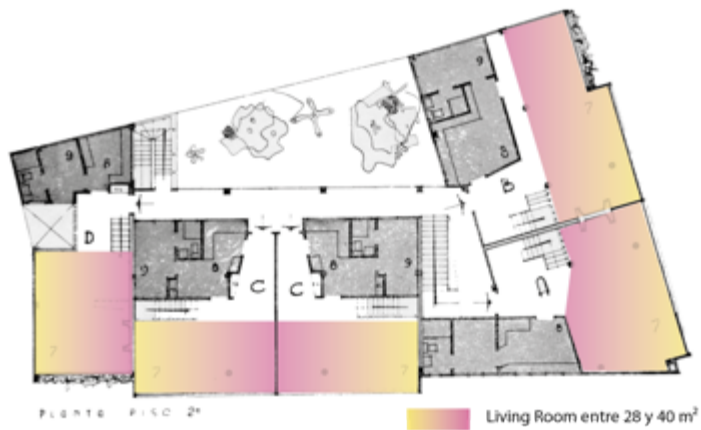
Planta 2 piso (primer nivel d6plex) del Edificio construido por Esguerra, S6enz, Urdaneta y Suarez – 1949
